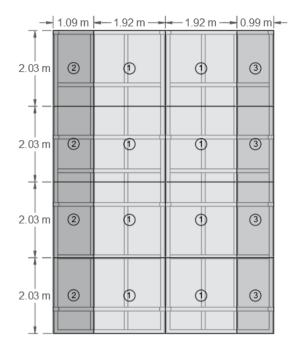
Vista en planta de las secciones tipo para losas de entrepiso.
